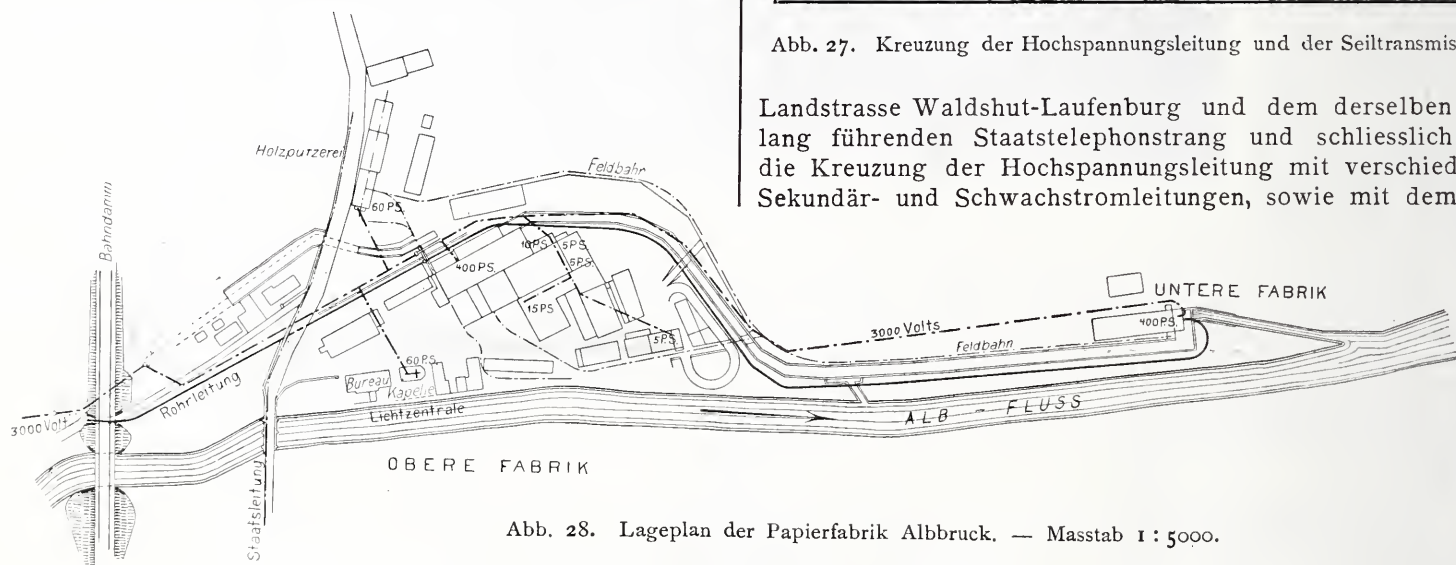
Lageplan der Papierfabrik Albrück. — Masstab 1:5000.
